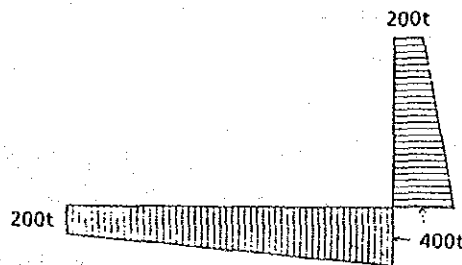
Tolerancia de fuerza cortante
